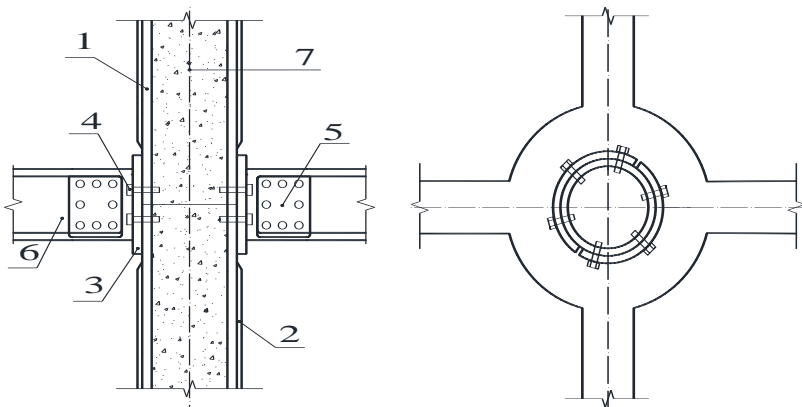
螺栓盖板连接钢筋混凝土梁节点
